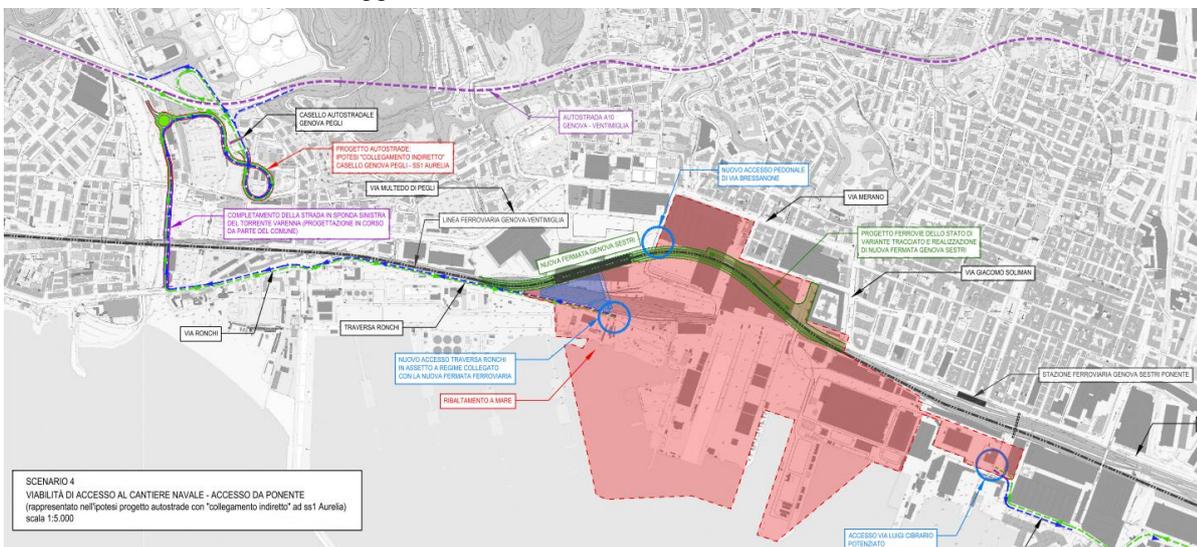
Area cantieristica – assetto futuro (non oggetto del PFTE)
